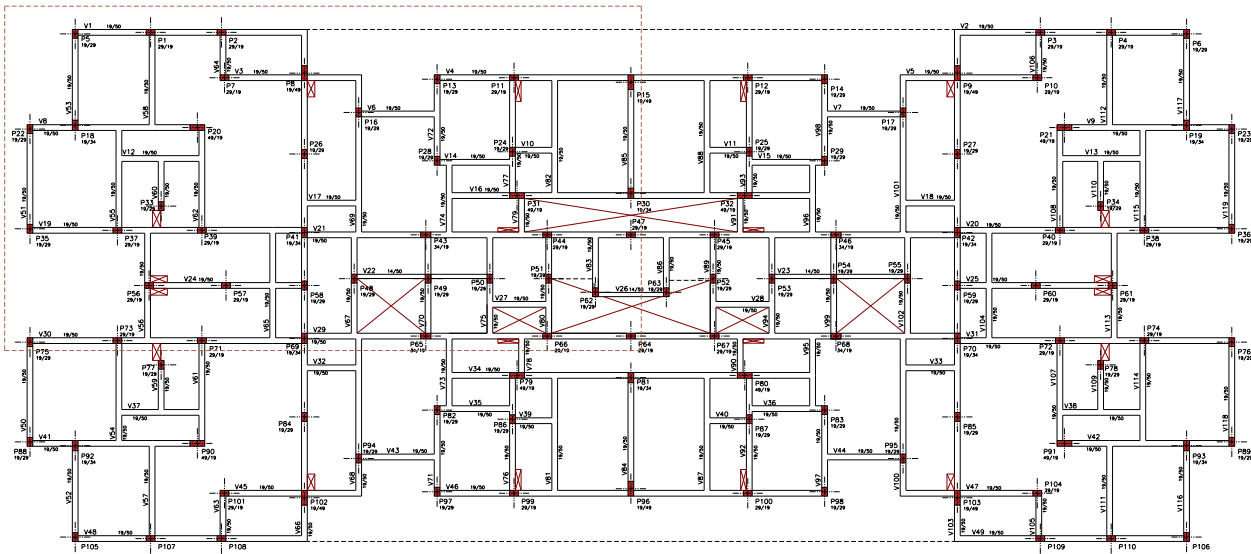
Edifício Way Peña: planta de formas do 1º pavimento (transição)
